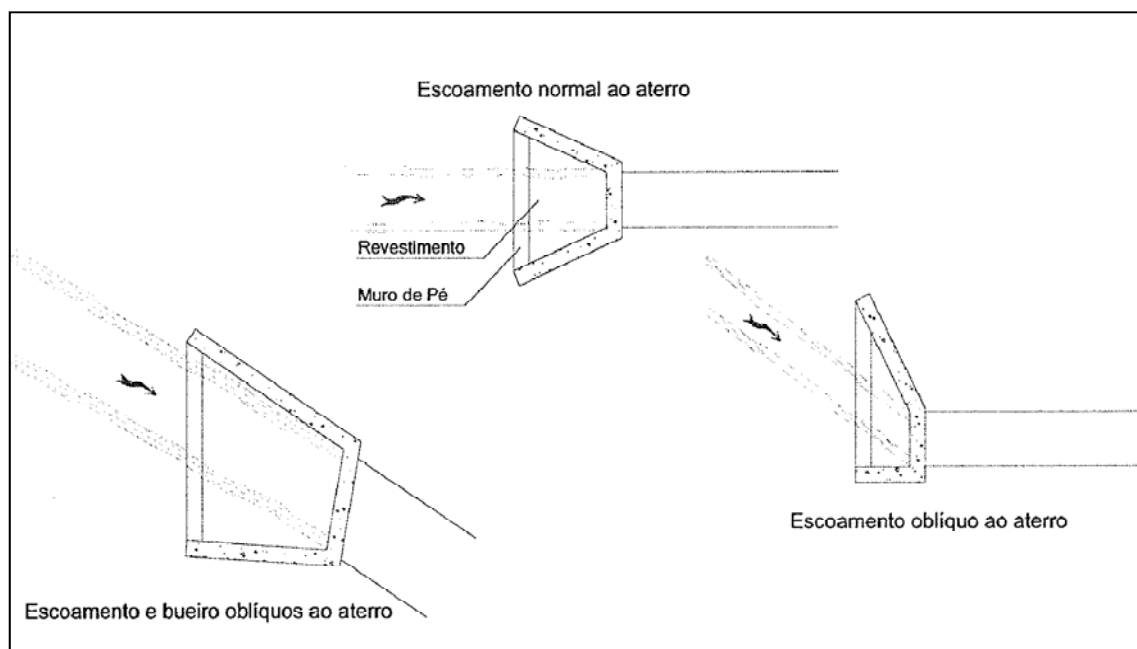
Configurações típicas de muro de testa e de muro de ala.
